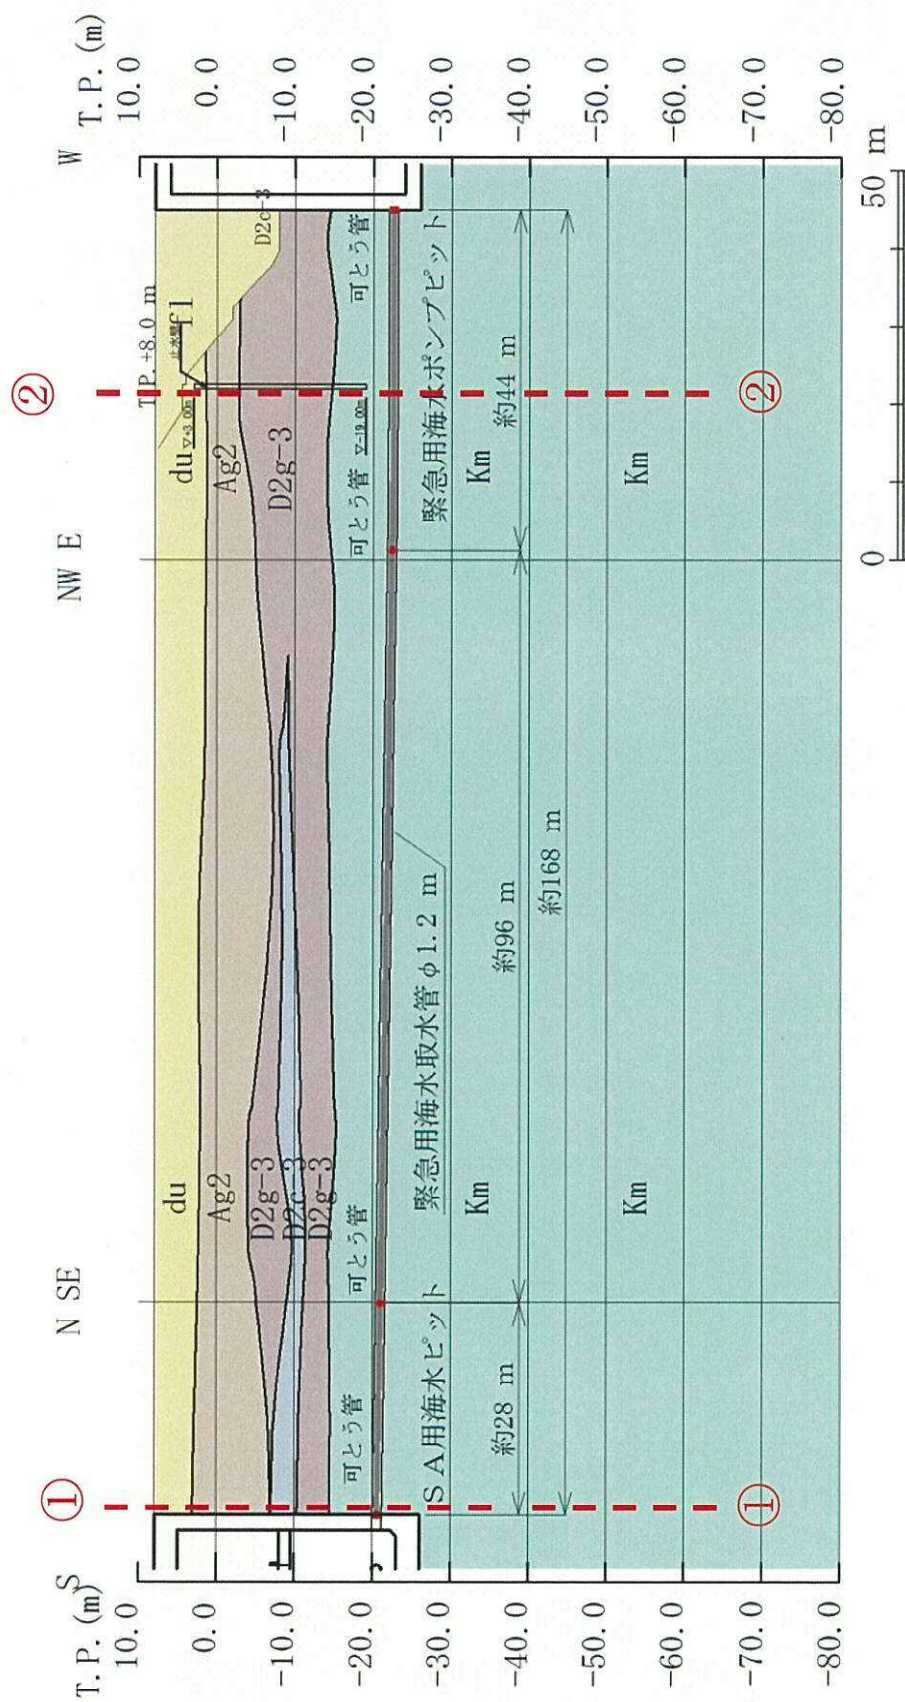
(1) 緊急用海水取水管 断面図 (A-A 縦断面)
